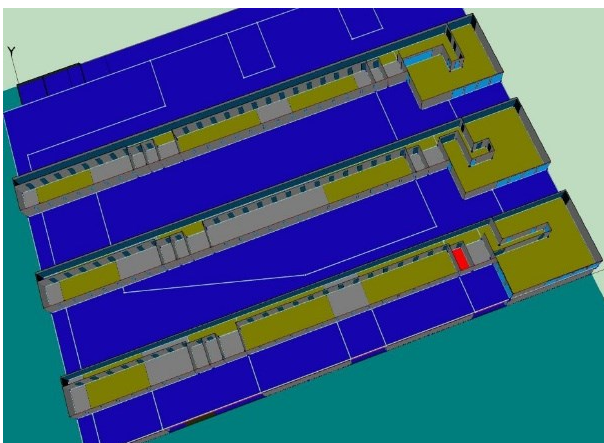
LIDER. Modelado finalizado Planta primera módulos
